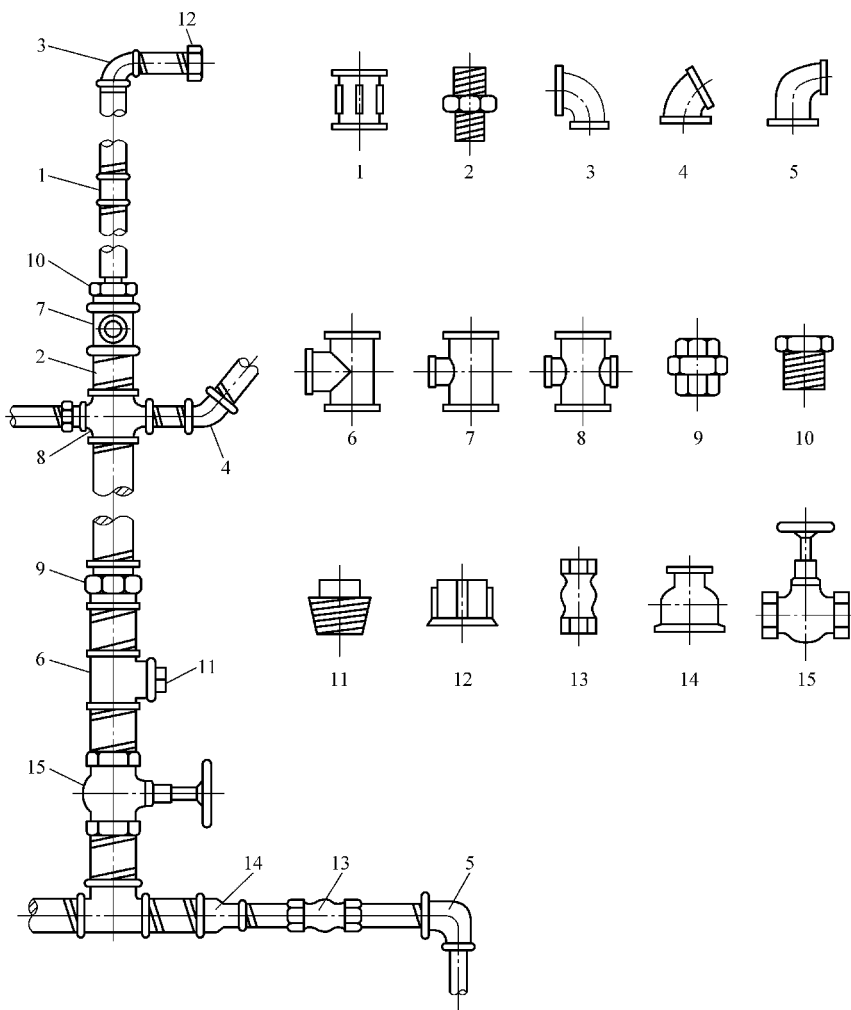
低压流体输送用焊接钢管螺纹连接配件
